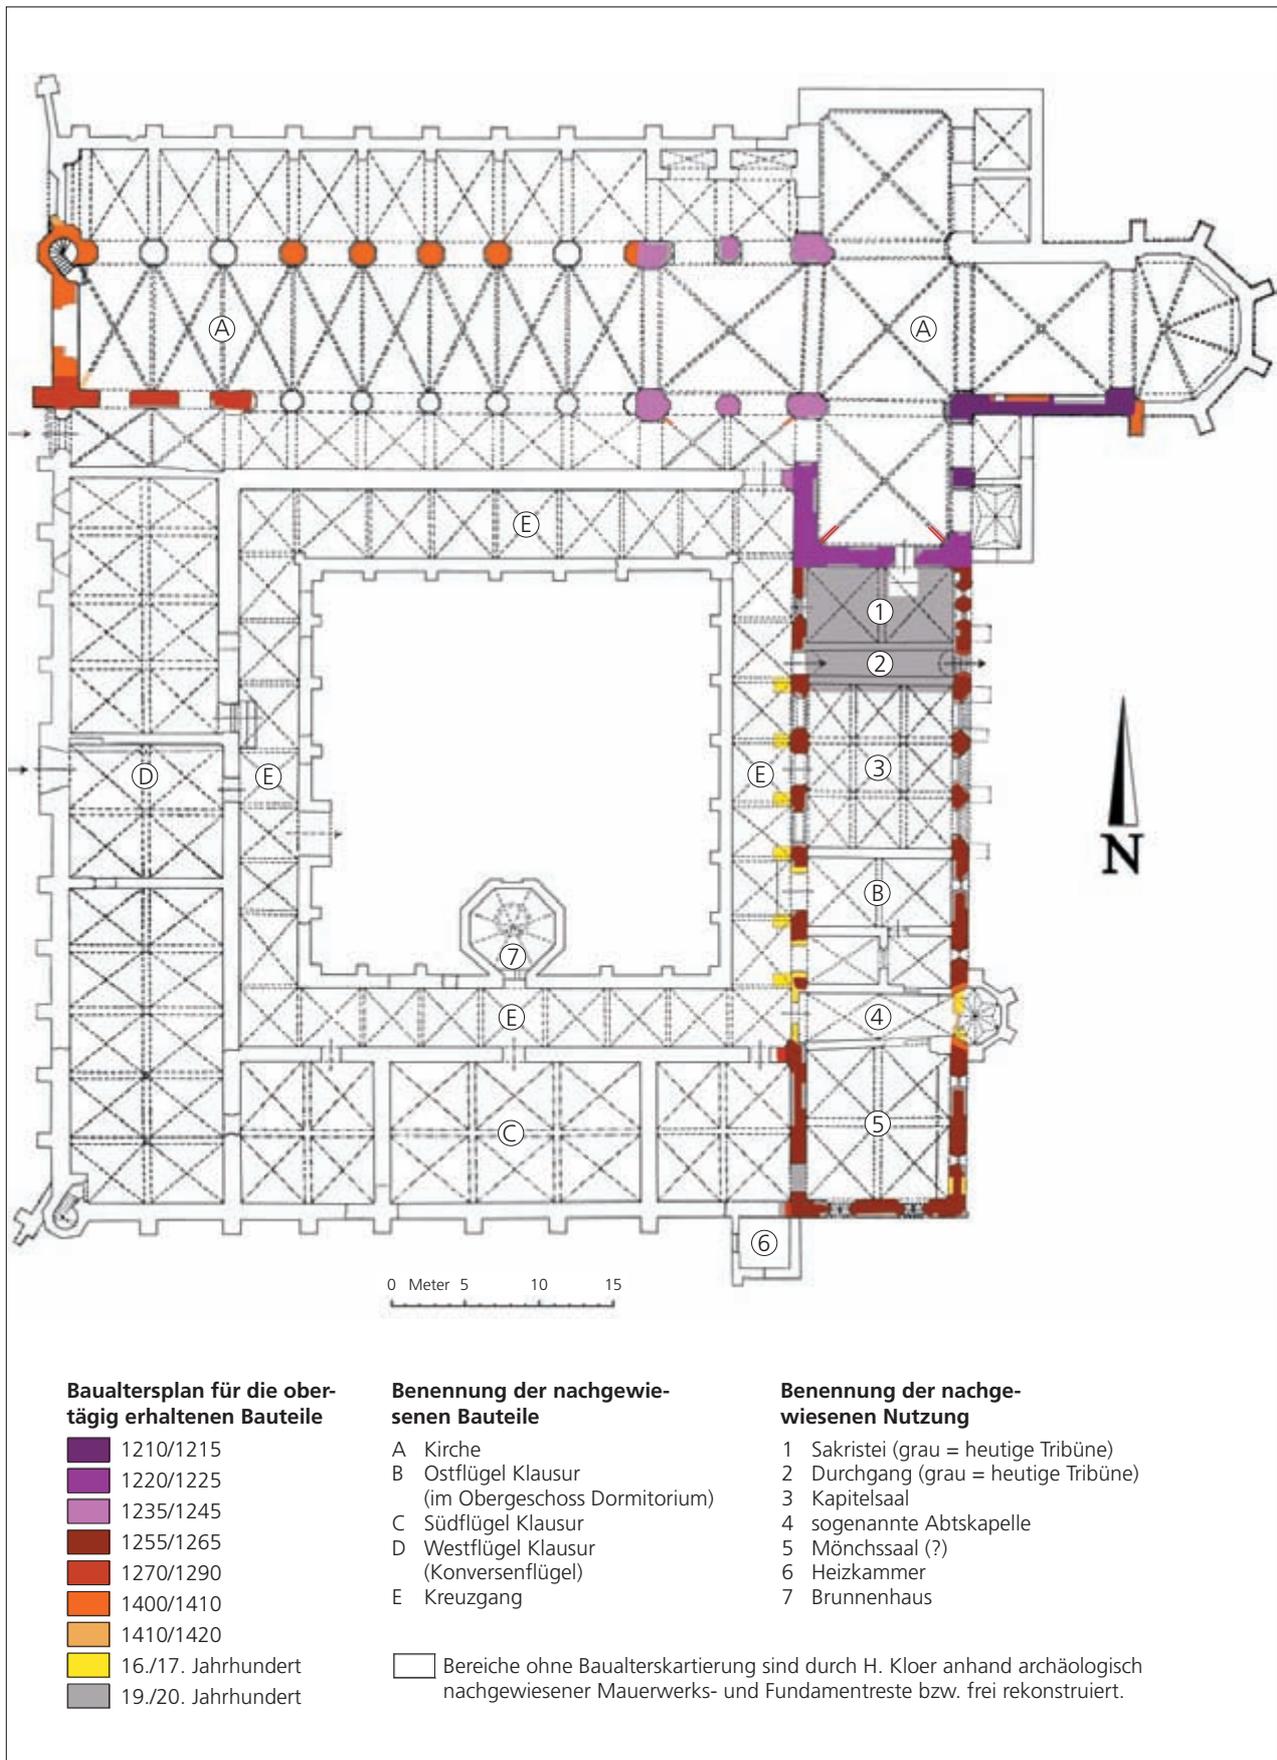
Klosterruine Eldena, Grundriss mit der Kartierung der wichtigsten Bauphasen
